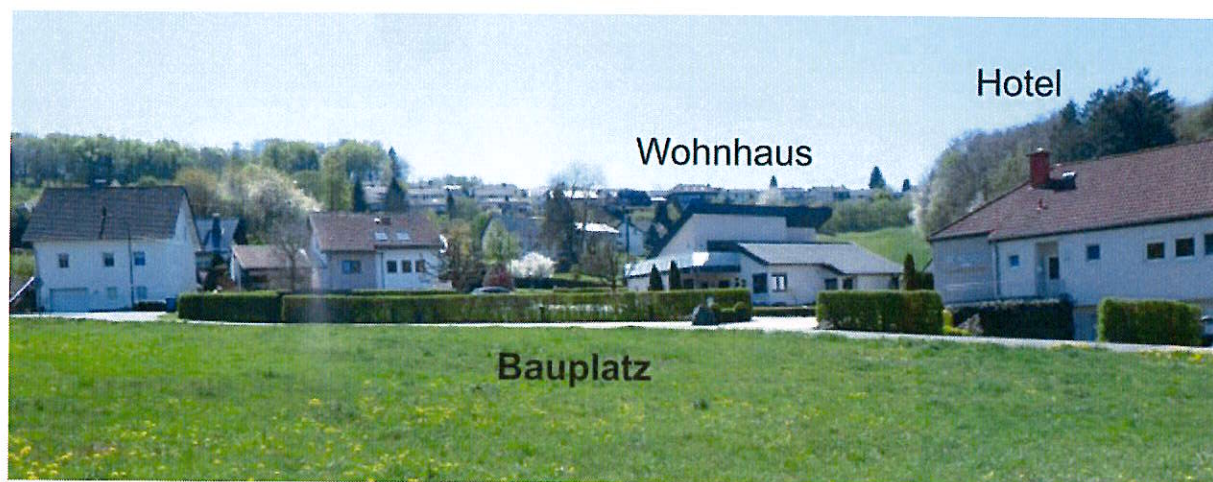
Lage des Bauplatzes mit Blick in Richtung Süden Quelle: Arch. Keukert
